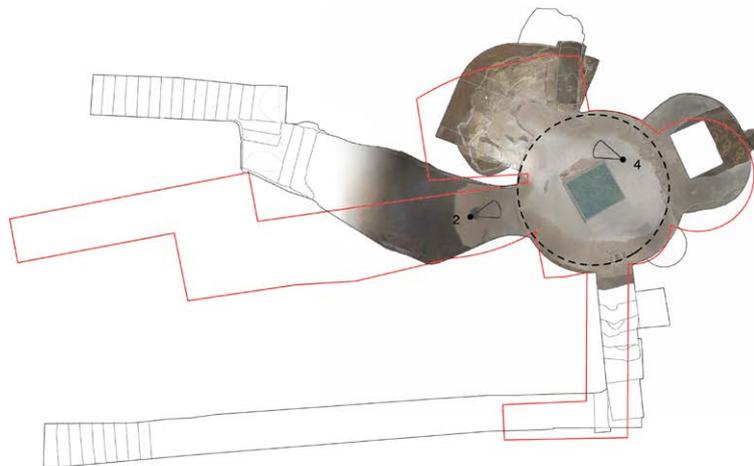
Pianta dell'ipogeo con ortofoto del piano di calpestio. In rosso la pianta di Houël estratta dall'assonometria cavaliera. A tratteggio la circonferenza desunta dalle tracce del rivestimento musivo. I coni ottici indicano i punti di presa delle fotografie in figura (fig. 2, 4). Elaborazione degli autori.
